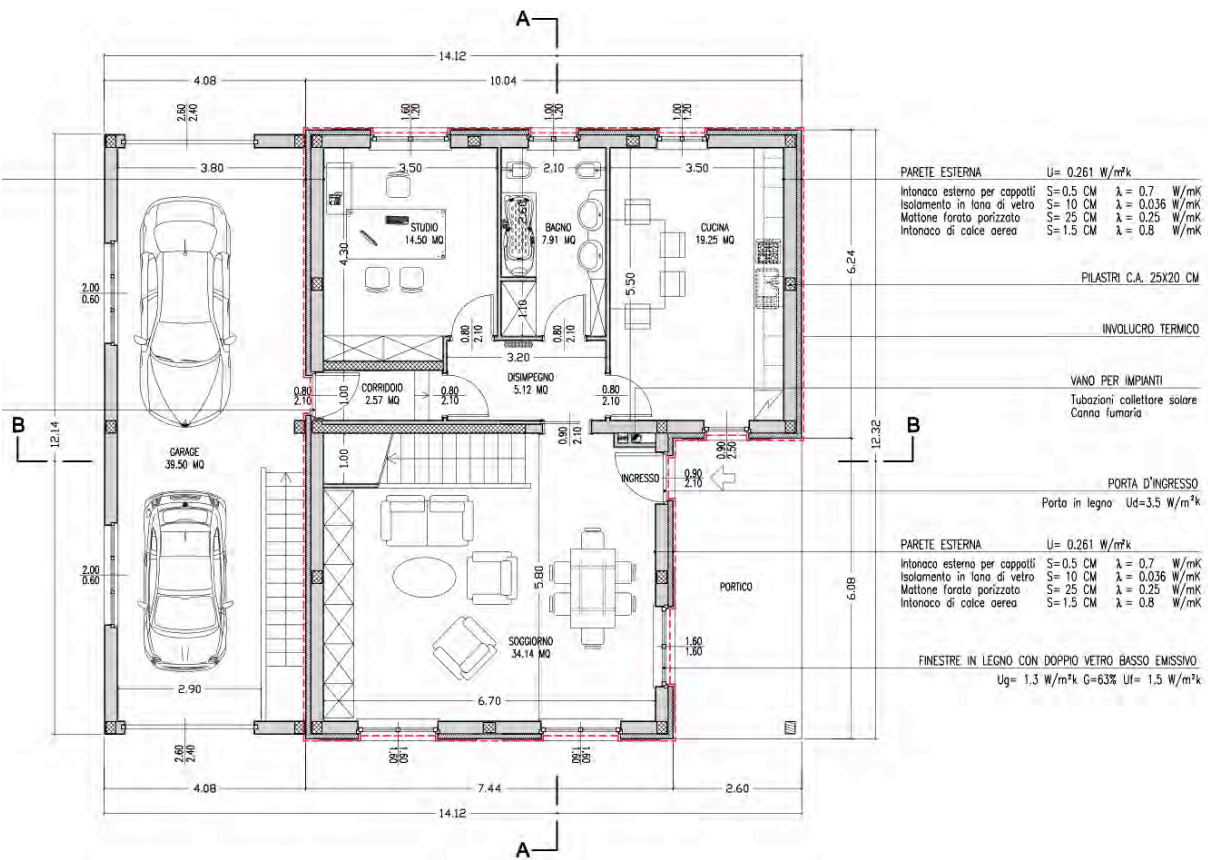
Villa singola 1: pianta P.T - archivio personale
